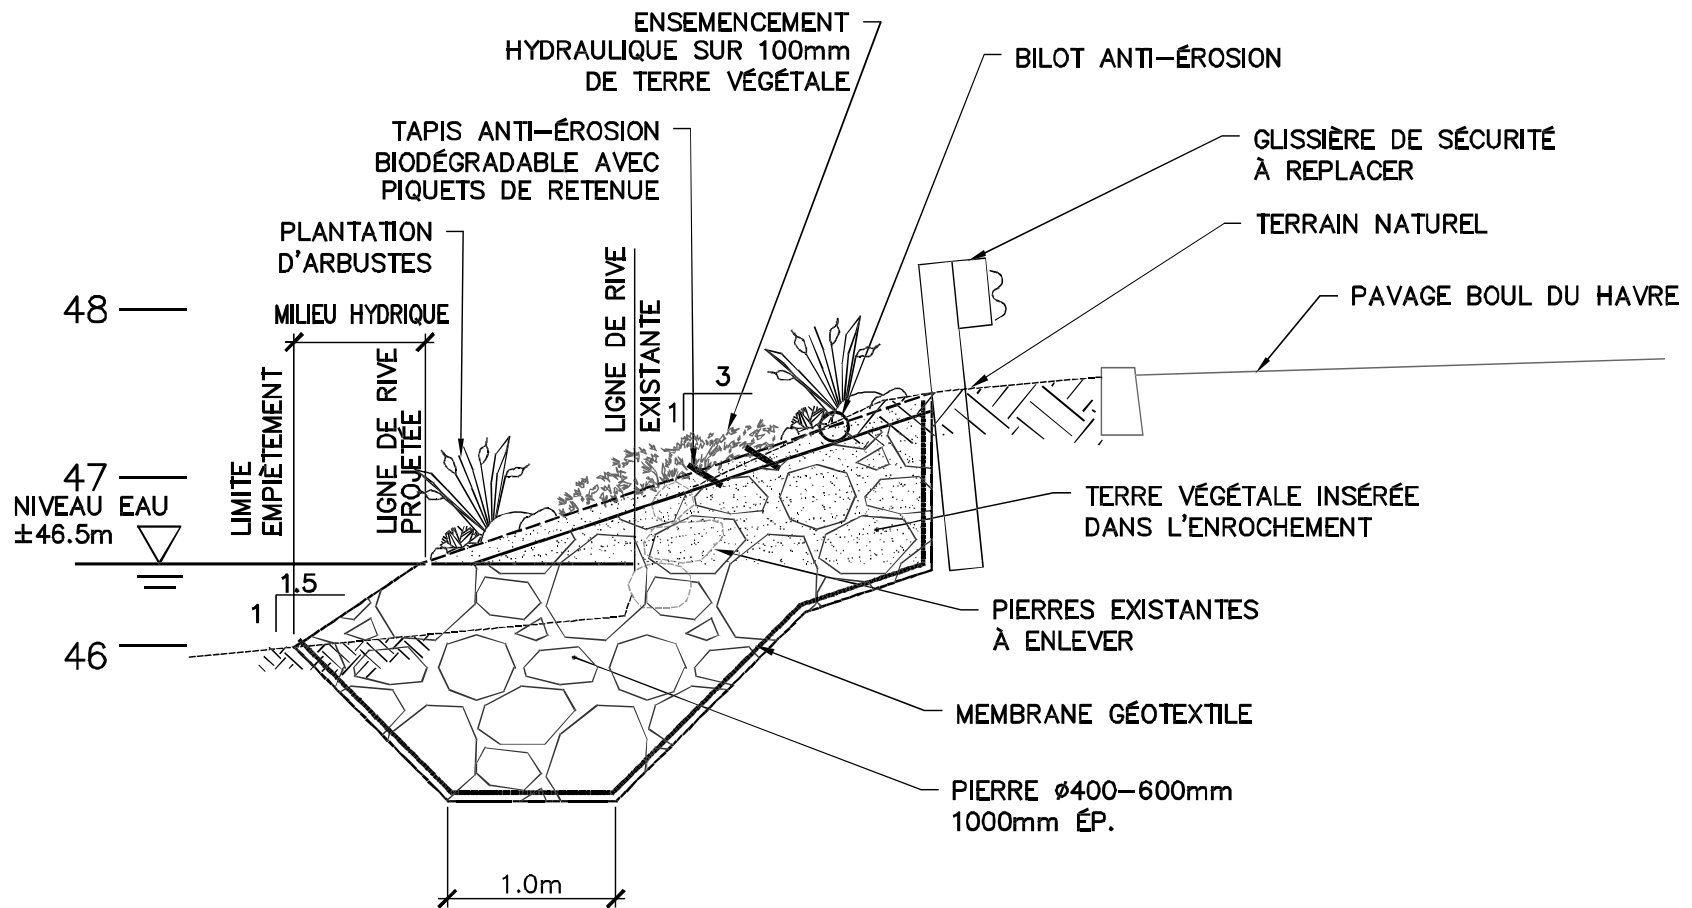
Coupe des travaux de stabilisation sur le boulevard du Havre Ouest (secteur du belvédère)
